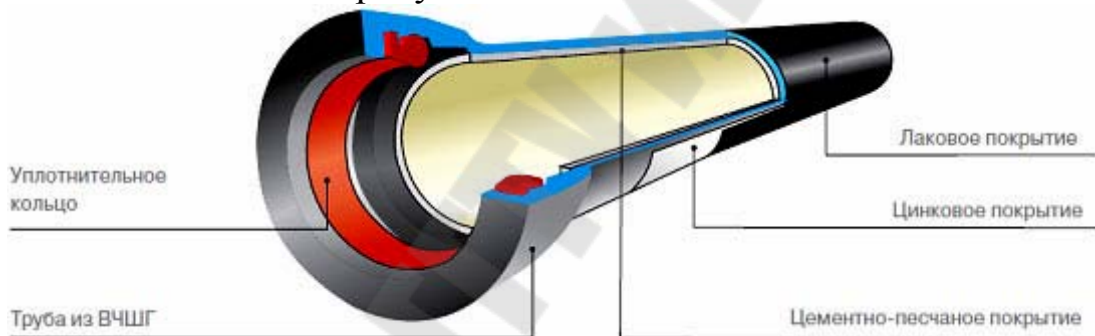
Конструкция чугунной трубы, монтаж которой производится без применения сварки
